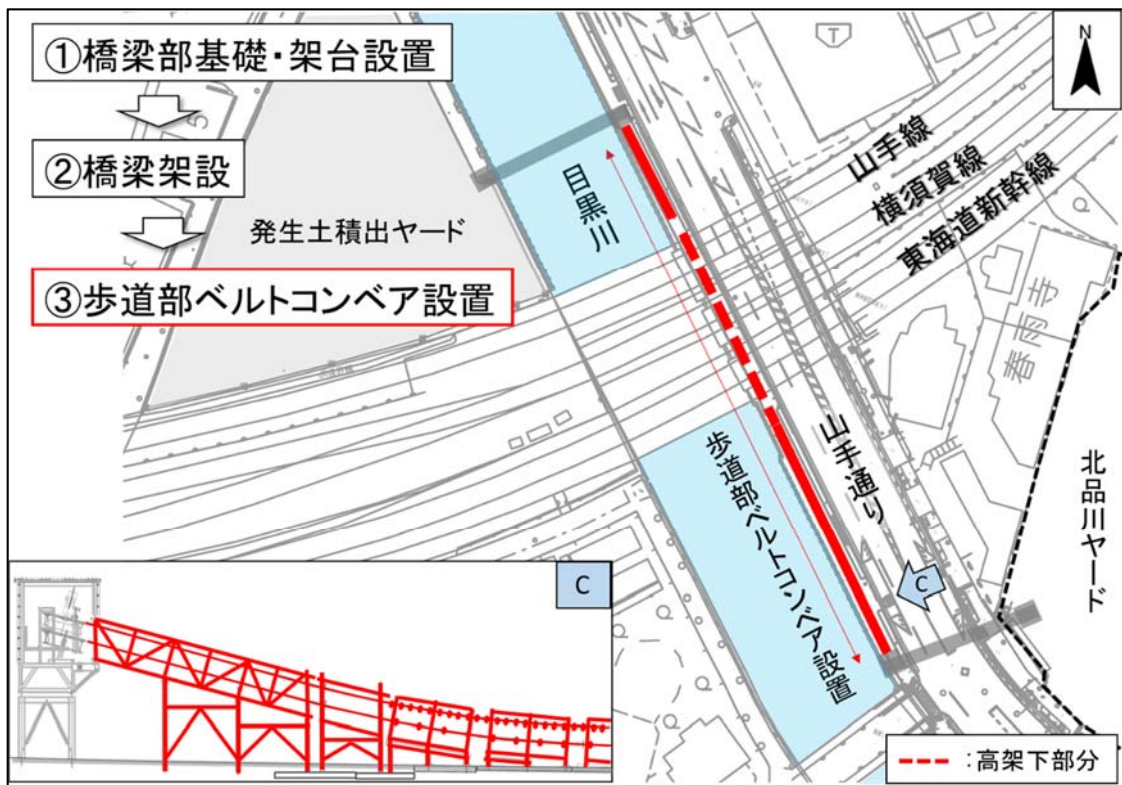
ベルトコンベア設置の施工手順 (③歩道部ベルトコンベア設置)
